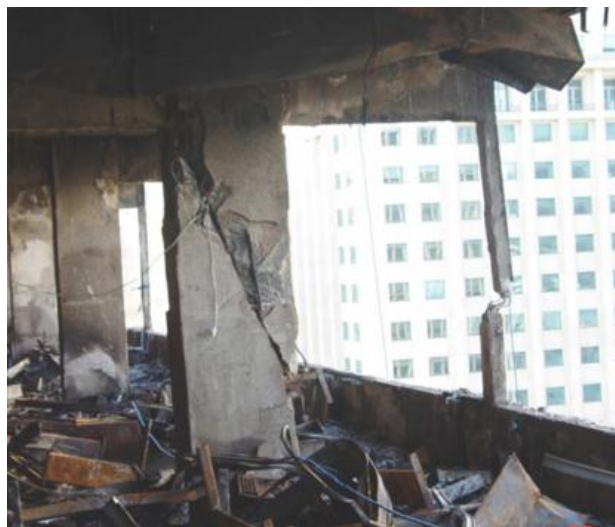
Rotura por corte de um pilar após exposição a incêndio (Santos et al., 2010).
